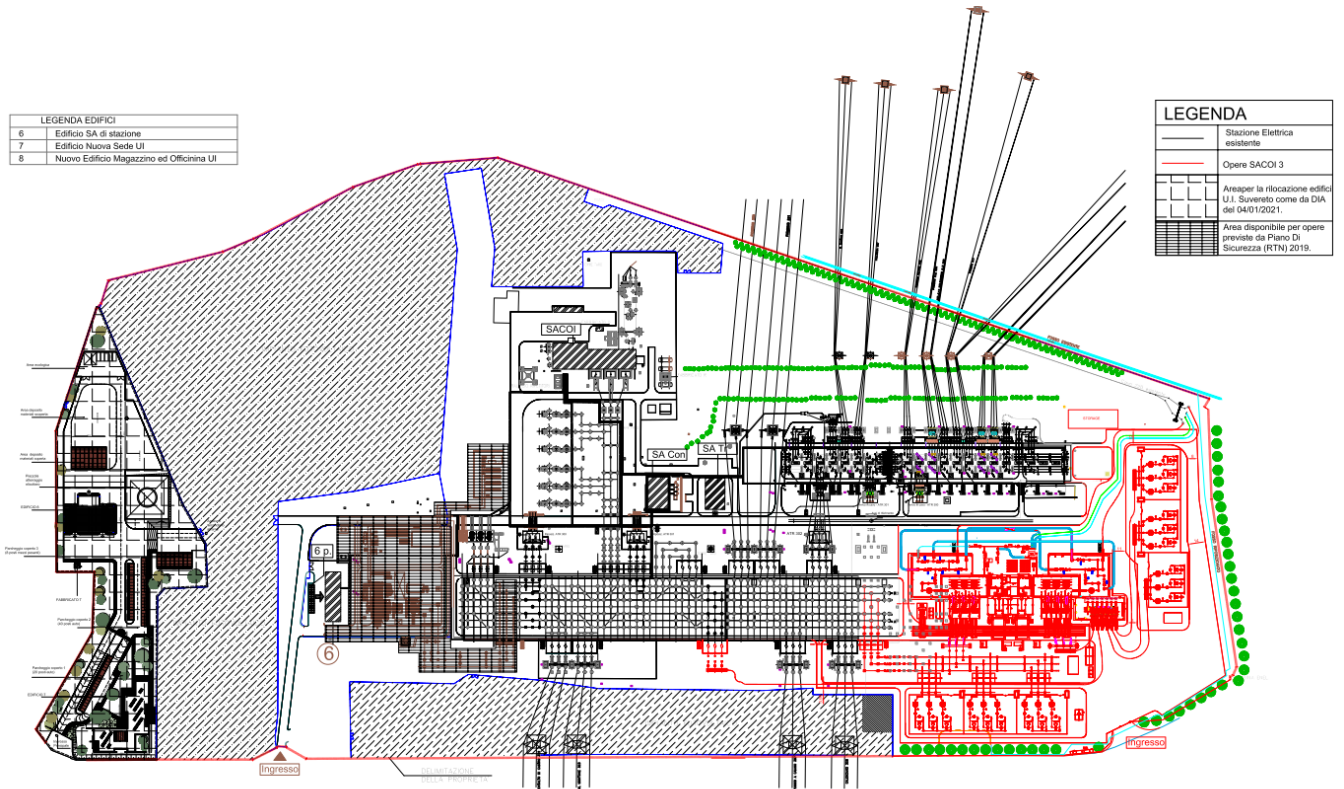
Intervento F: layout stazione esistente di Suvereto e individuazione delle opere in progetto per l'intervento SA.CO.I.3
